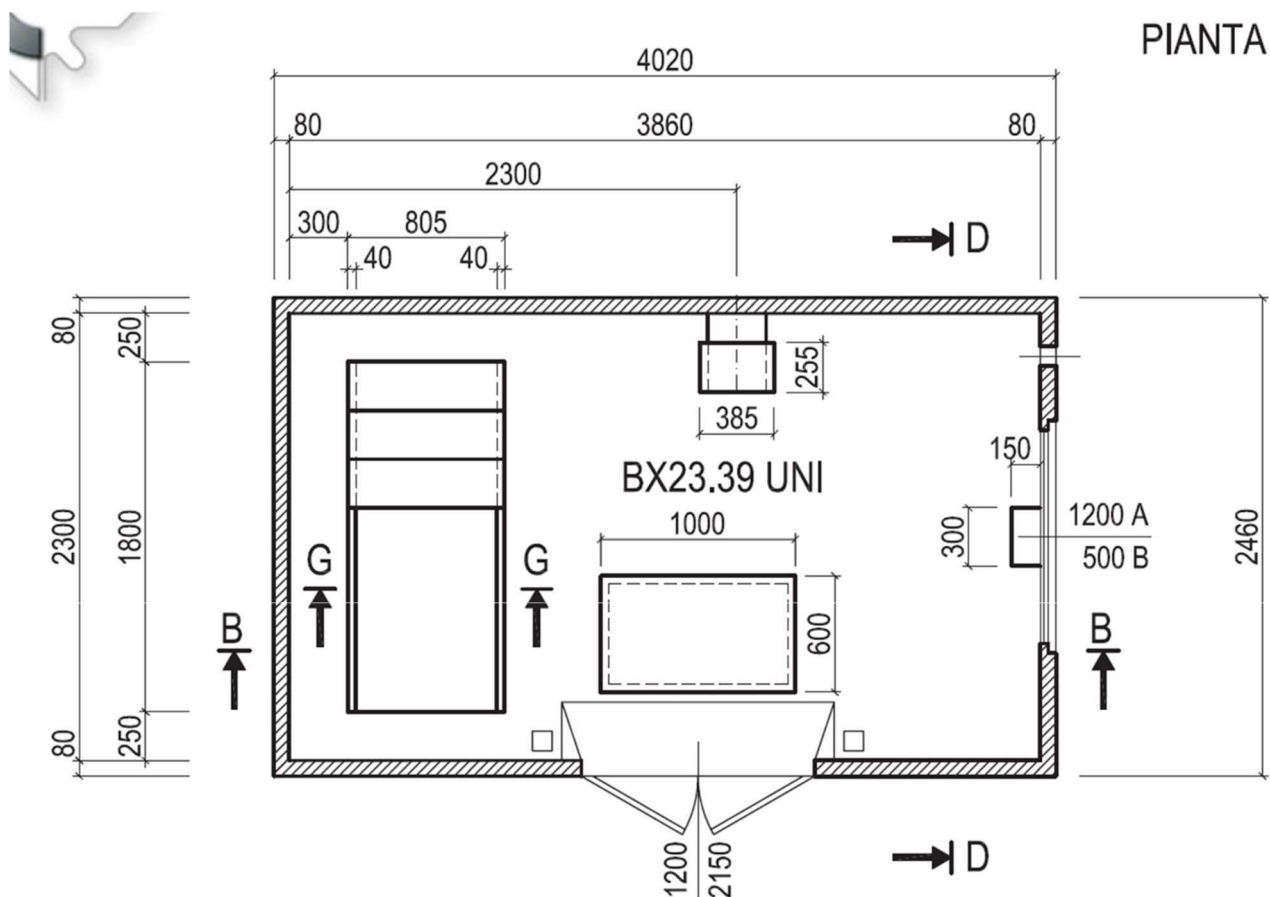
Rappresentazione di una tipica cabina di sezionamento secondo Standard ENEL DG 2061: pianta
